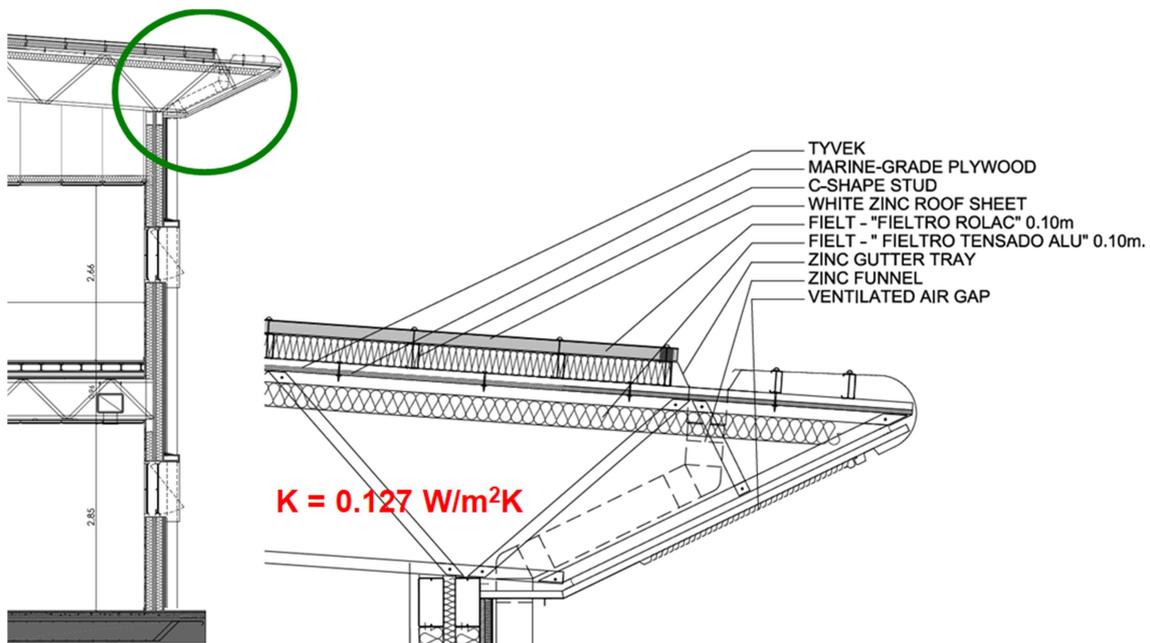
Detalle de la resolución constructiva del muro oeste.
